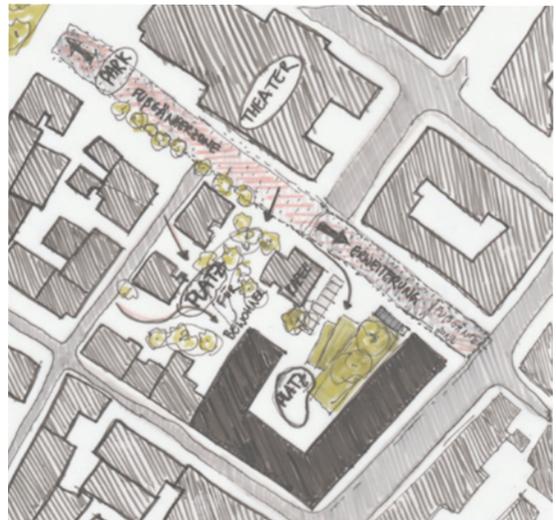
Vierte Variante mit teilweise geöffnete Blockrandbebauung
